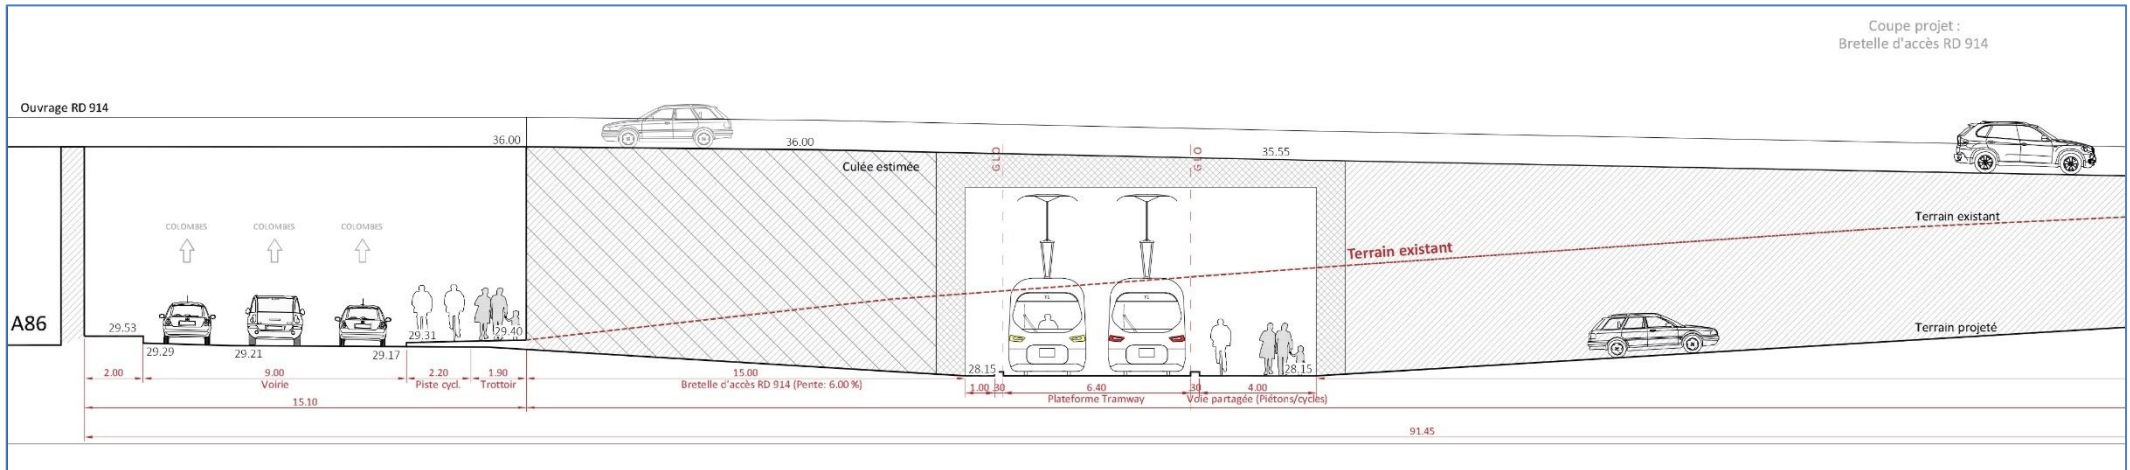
Séquence 1 – section D – Franchissement avec croisement – bretelle d'entrée
